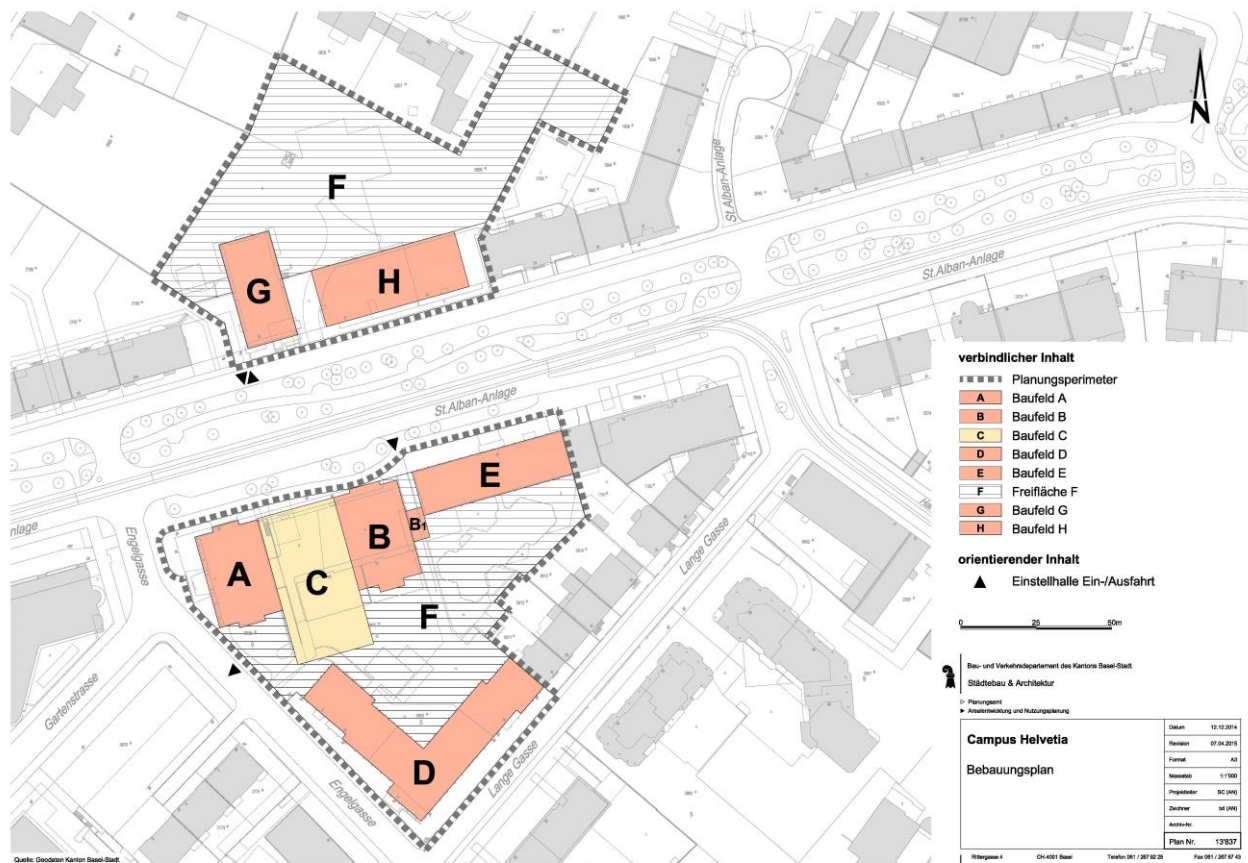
Neuer Bebauungsplan. Plan Nr. 13'837 (Ohne Massstab, Plan genordet)
